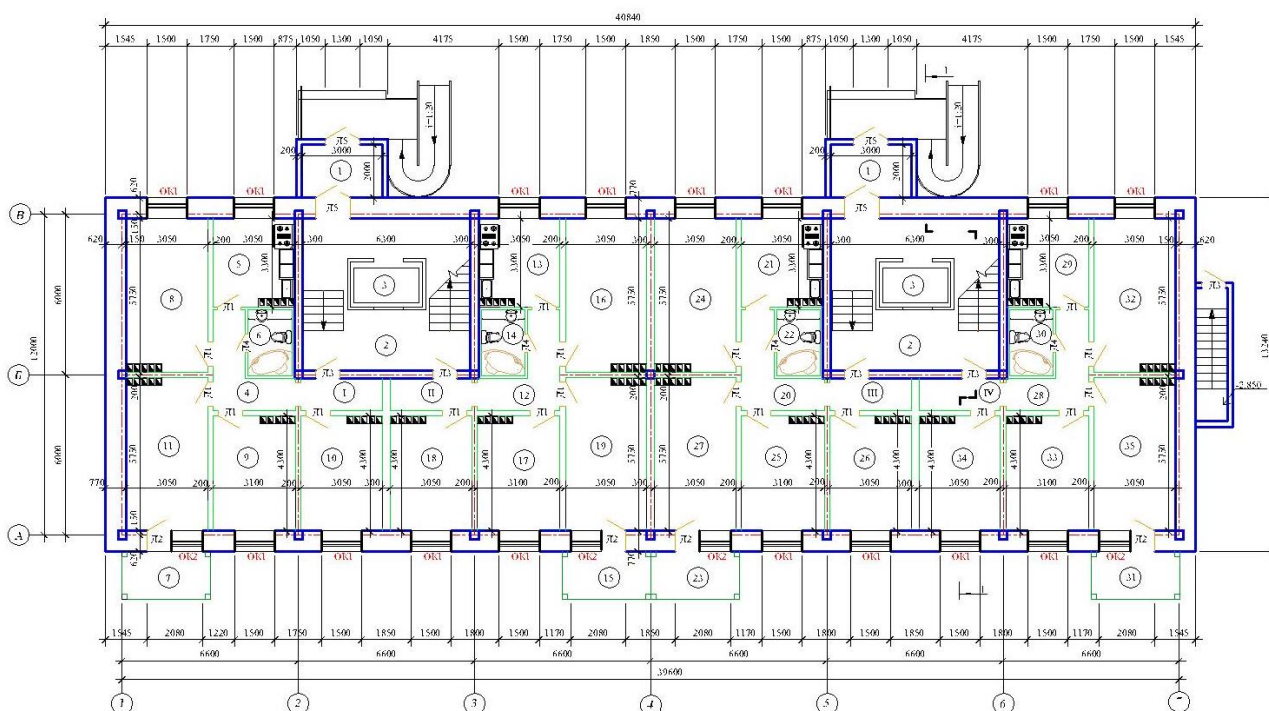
План первого этажа пятиэтажного жилого пассивного дома
